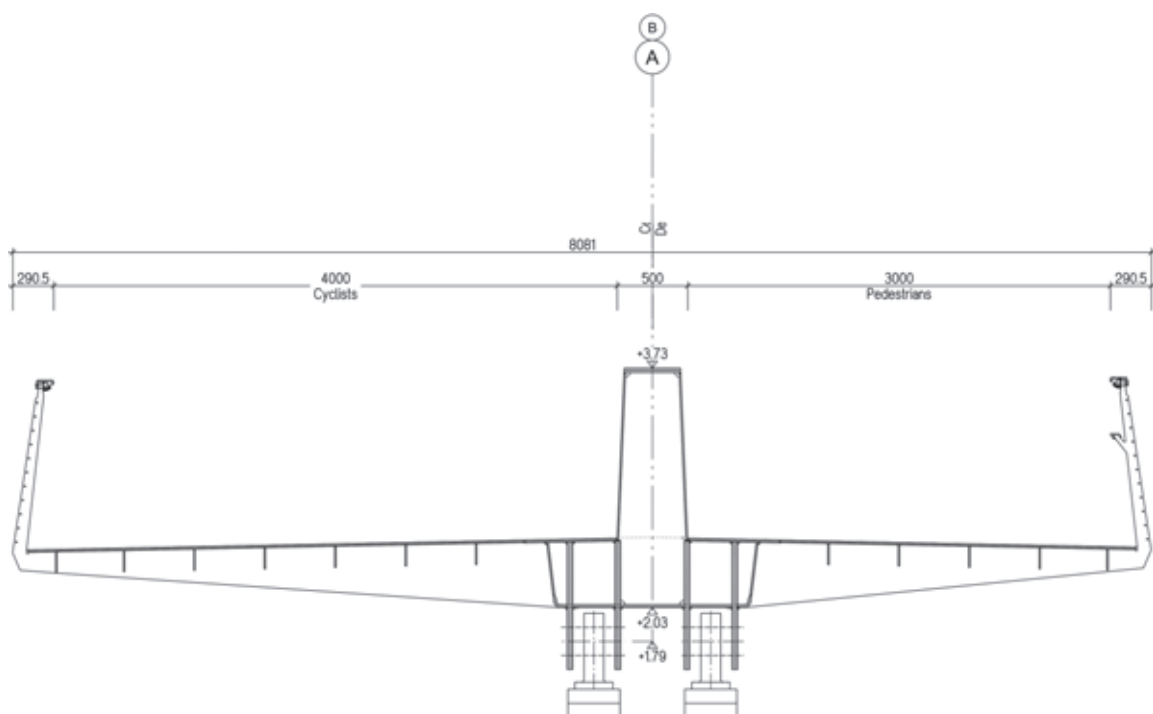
Querschnitt am Hydraulikzylinderaufleger
